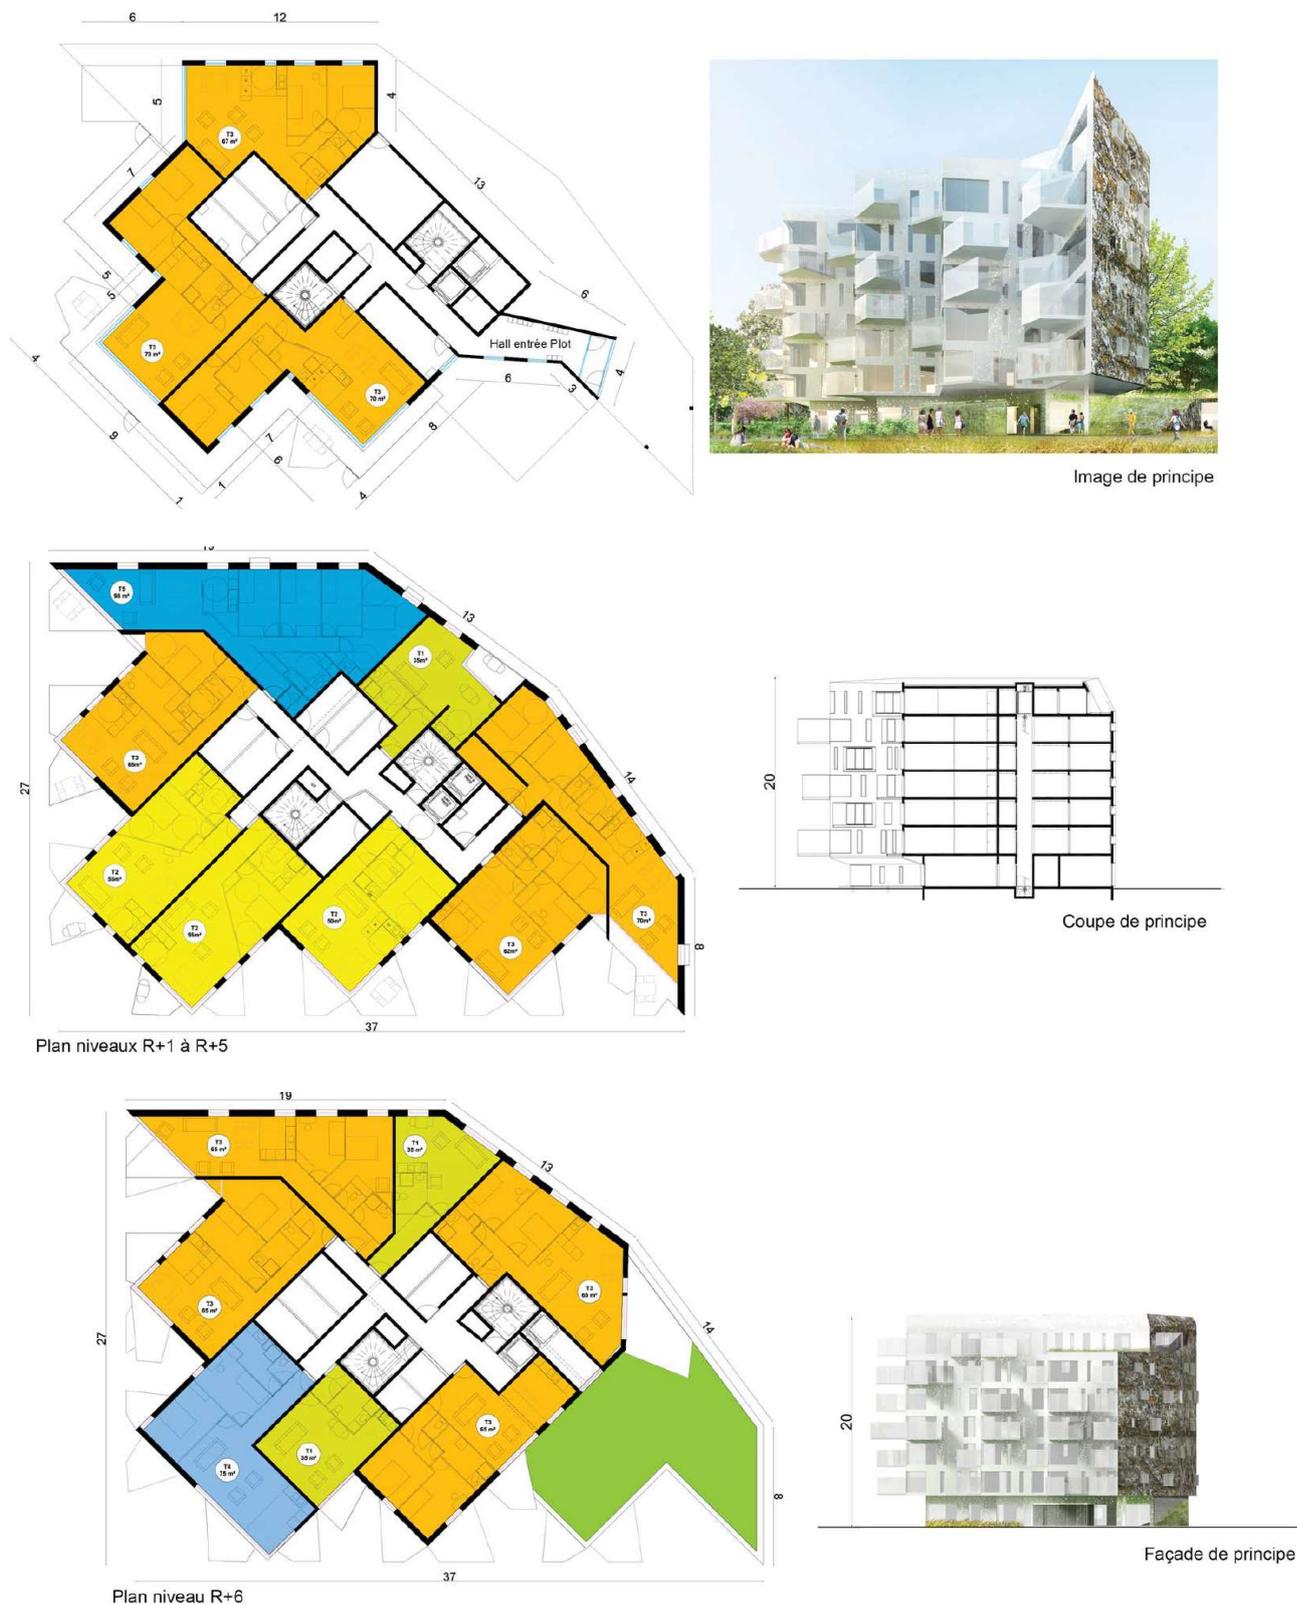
Traitement des façades – (BERNARD BÜLHER ARCHITECTE)
